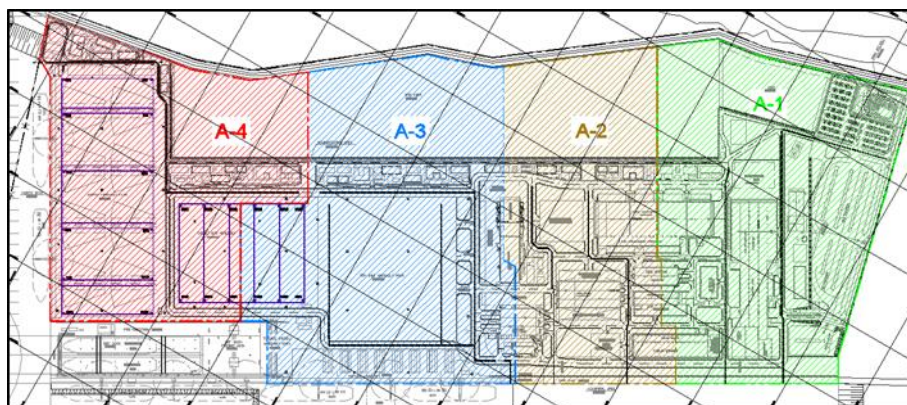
Planta das áreas de planejamento da rede de drenagem. Fonte: Projeto OSX
